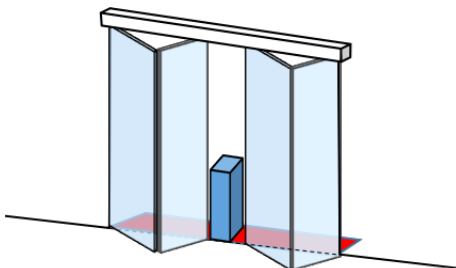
Ensayo de la protección mediante sensores en el movimiento de cierre de puertas plegables
